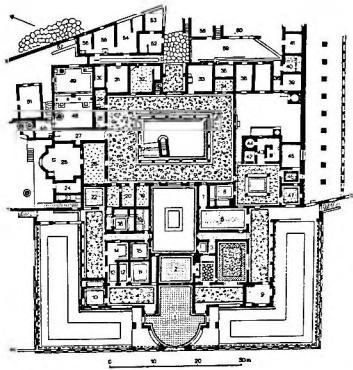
Idem. villa dei Misteri. Planimetria do edificio na fase final (Maiuri,1931, tav. A).
